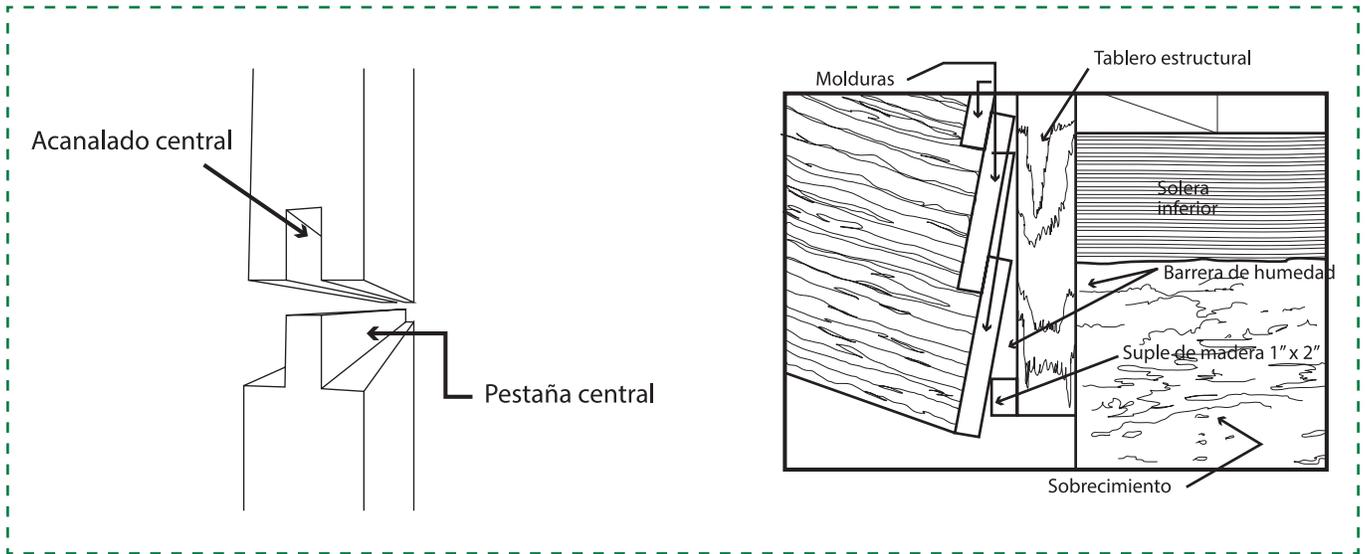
Revestimiento de tablero de contrachapado estructural, construcción de viviendas en madera
